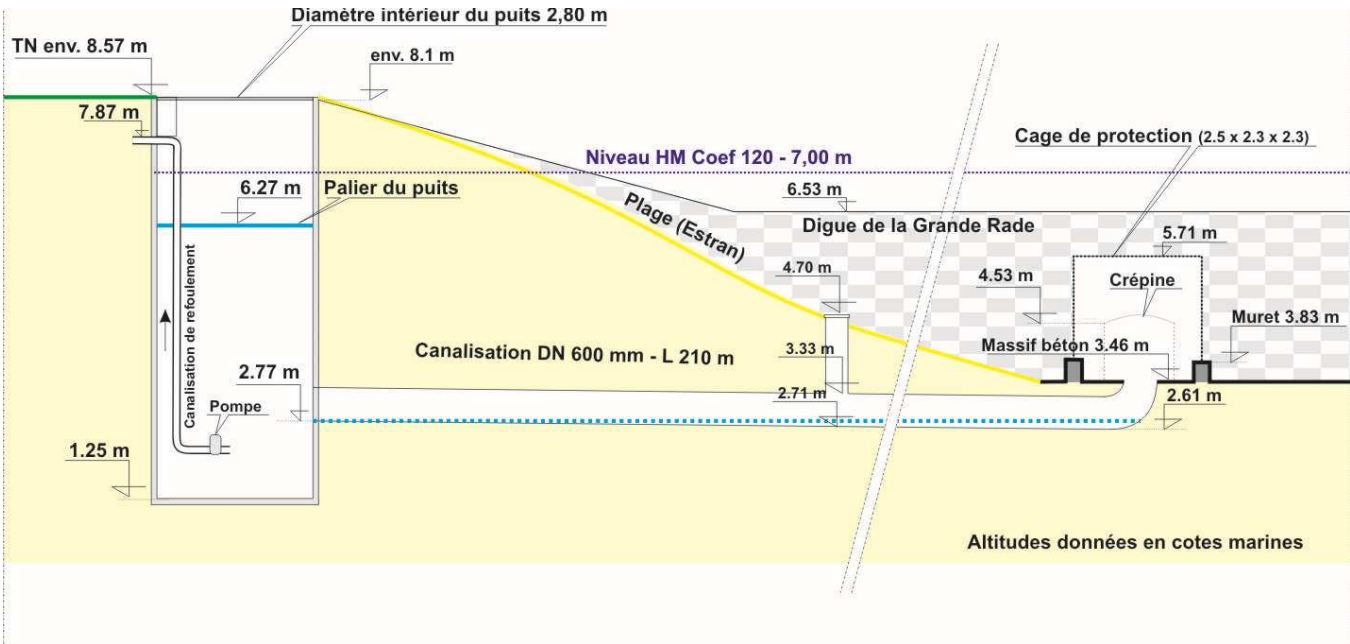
Coupe schématique longitudinale de la prise d'eau existante
